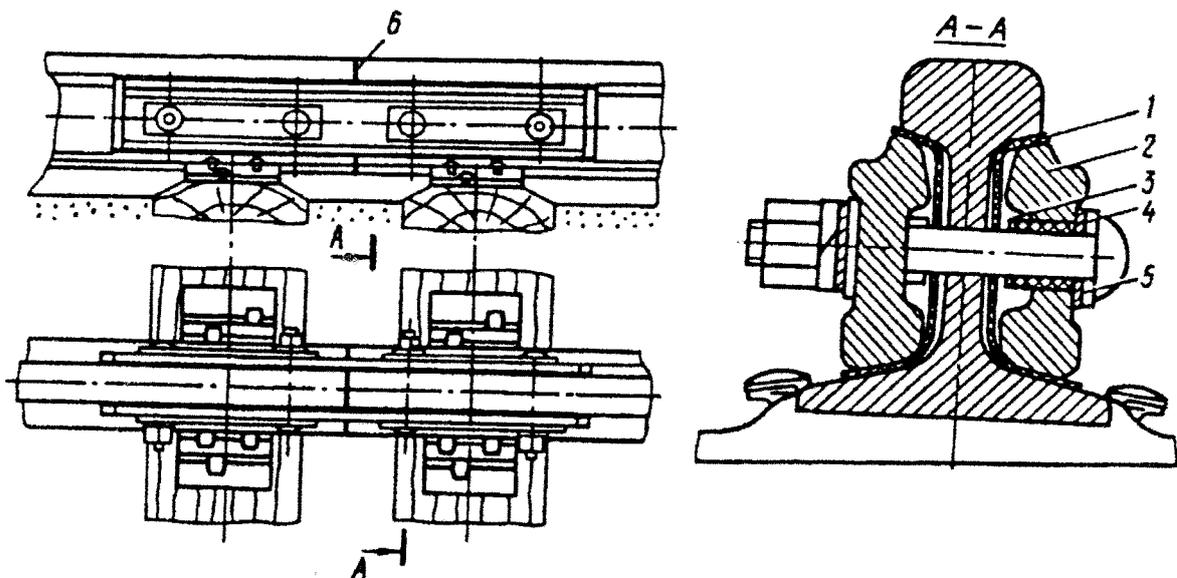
Изолирующий стык с двухголовыми металлическими накладками для пути с деревянными шпалами:
